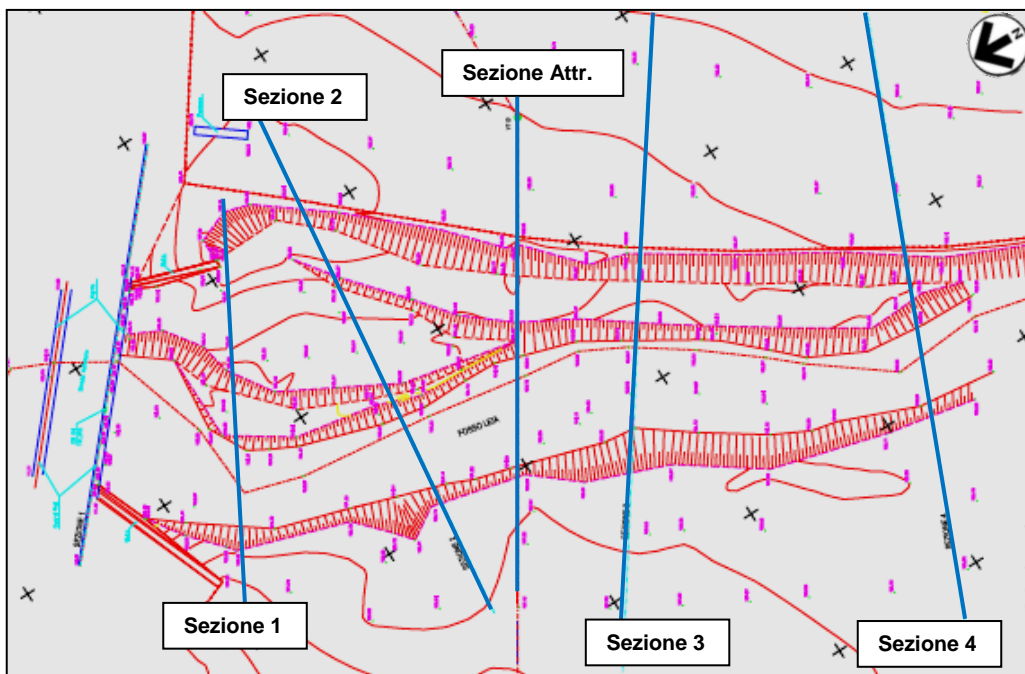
/A – Planimetria con localizzazione delle sezioni
